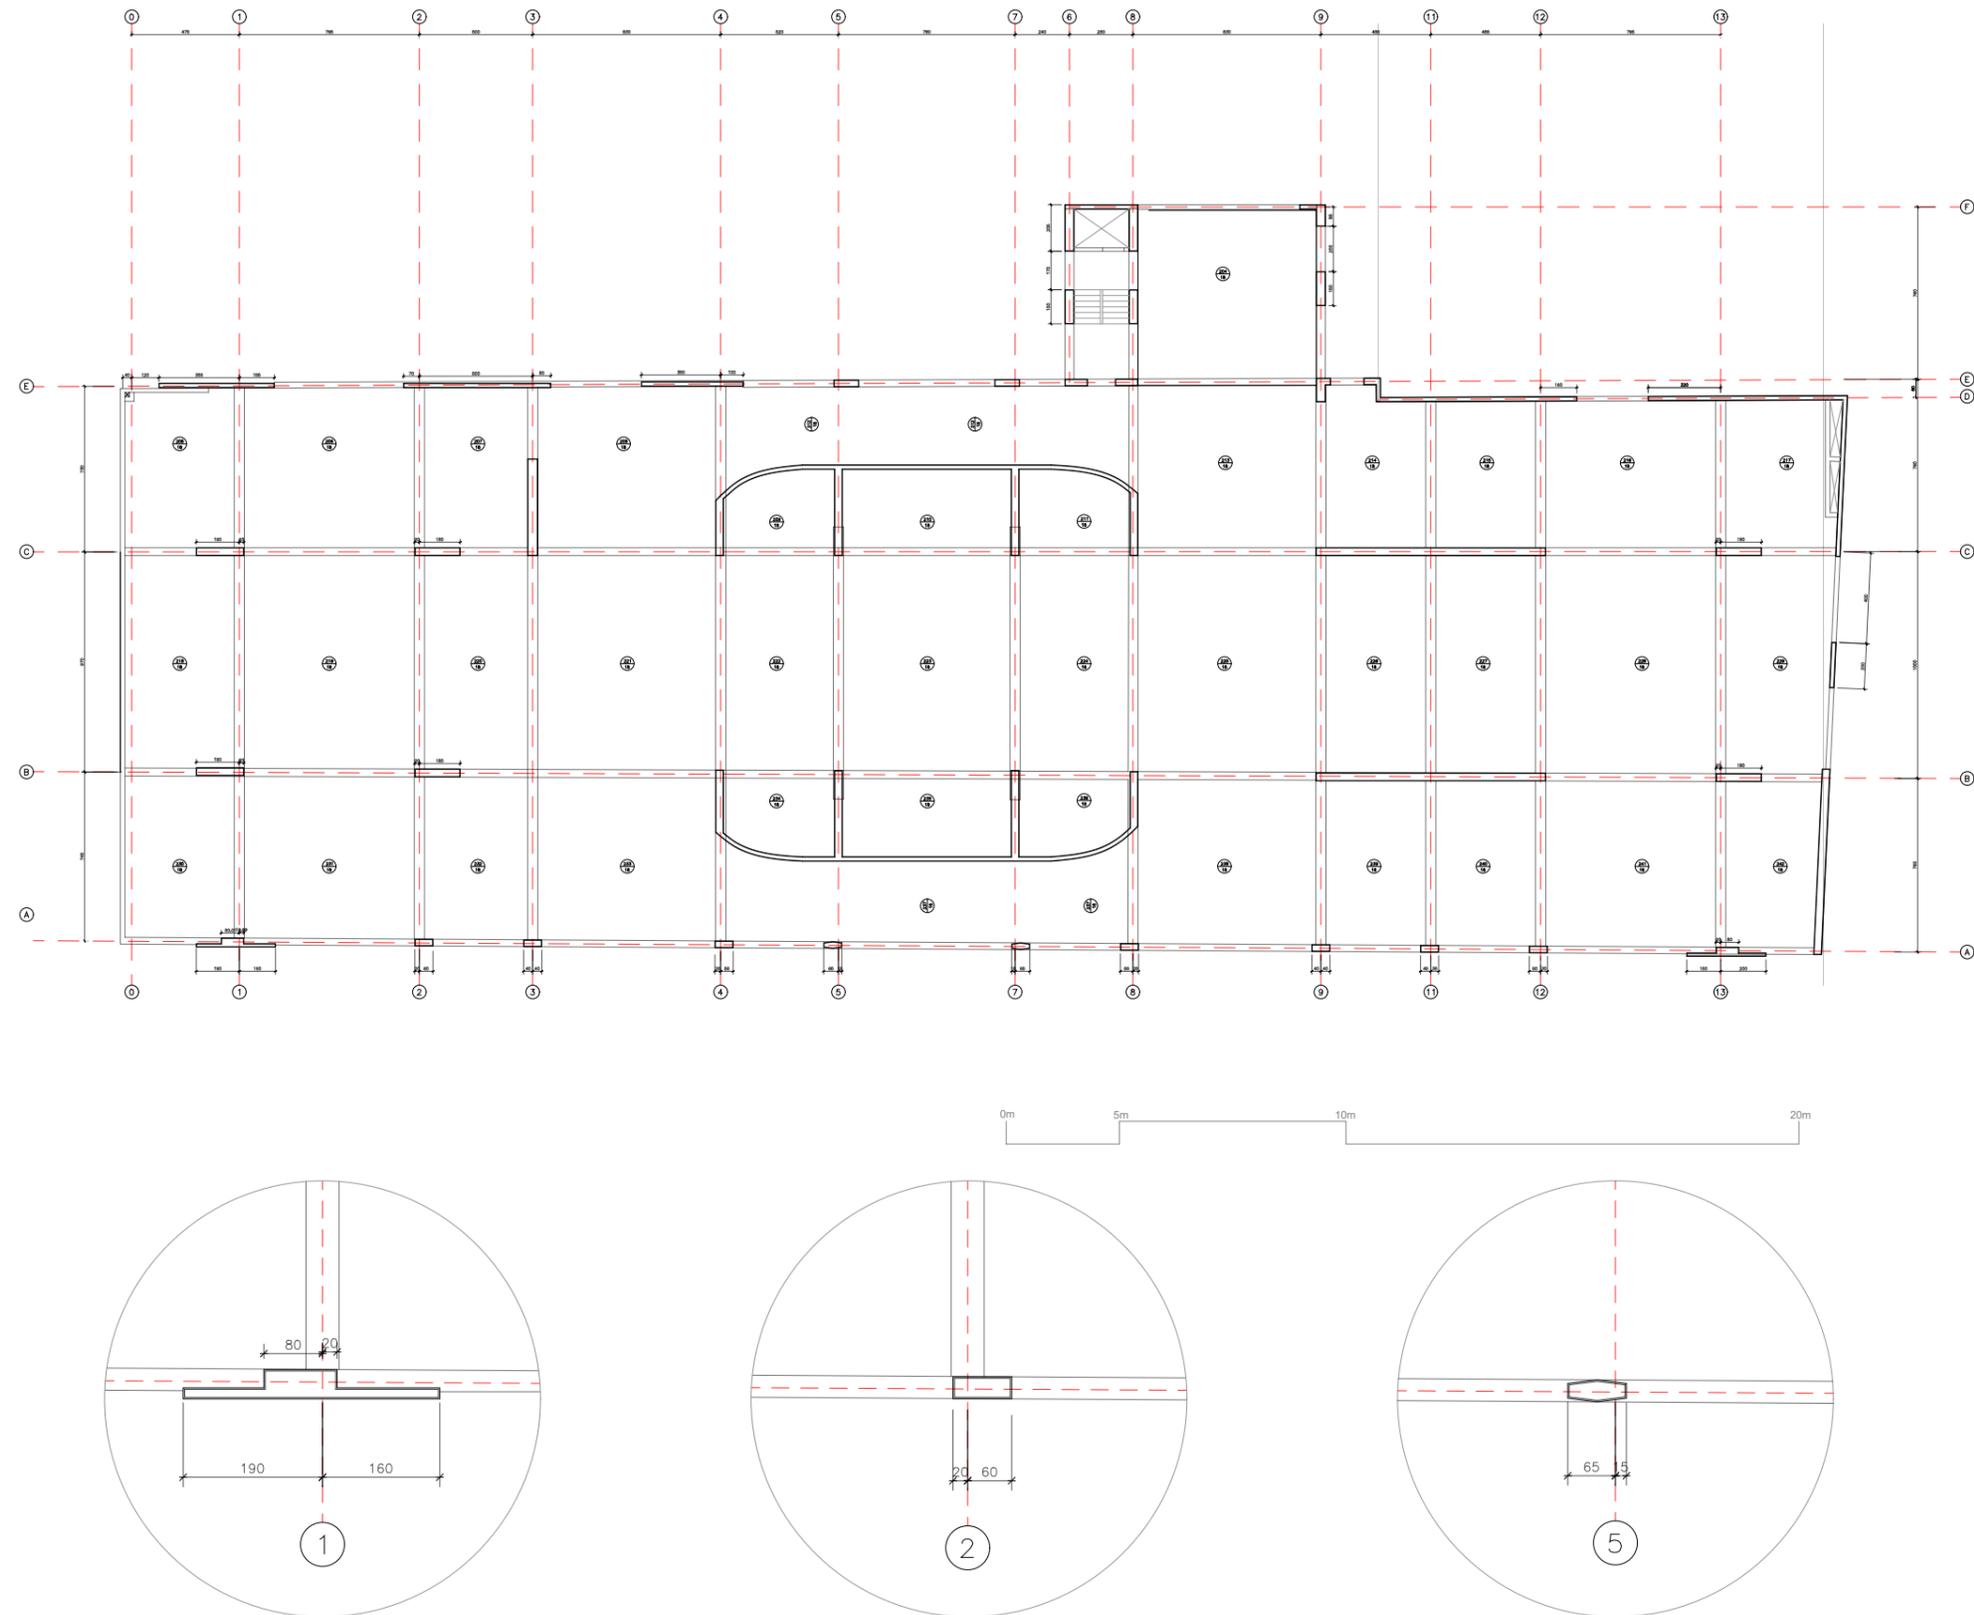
Fuente: Elaboración Propia. Basado en plano municipal.
